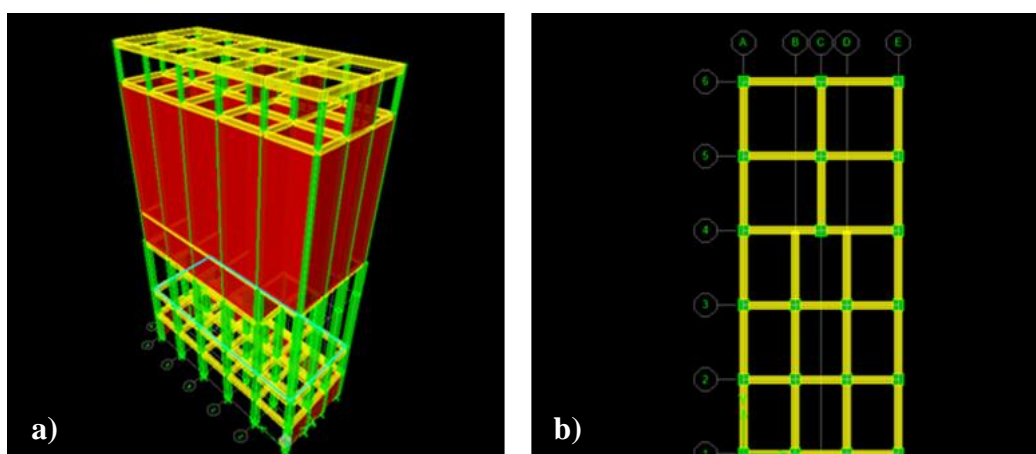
Estructura de silos de Harina: a) vista en elevación; b) vista en planta
